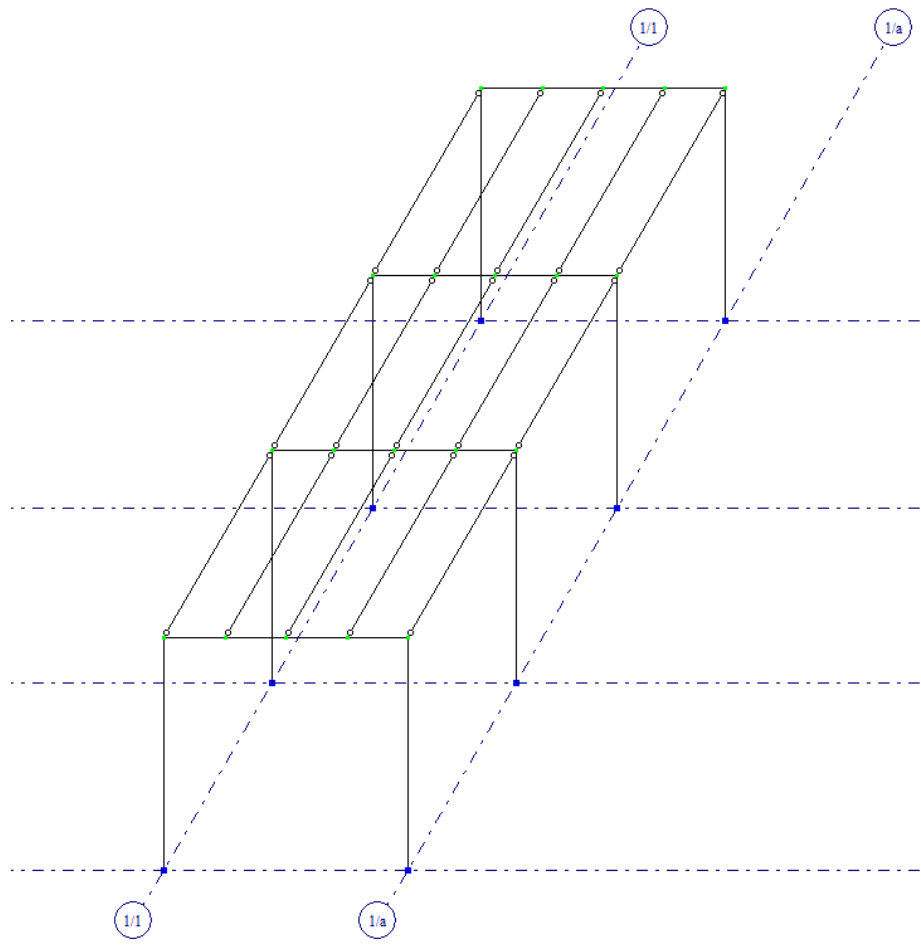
Схема розташування балок перекриття на відм. +21,000
